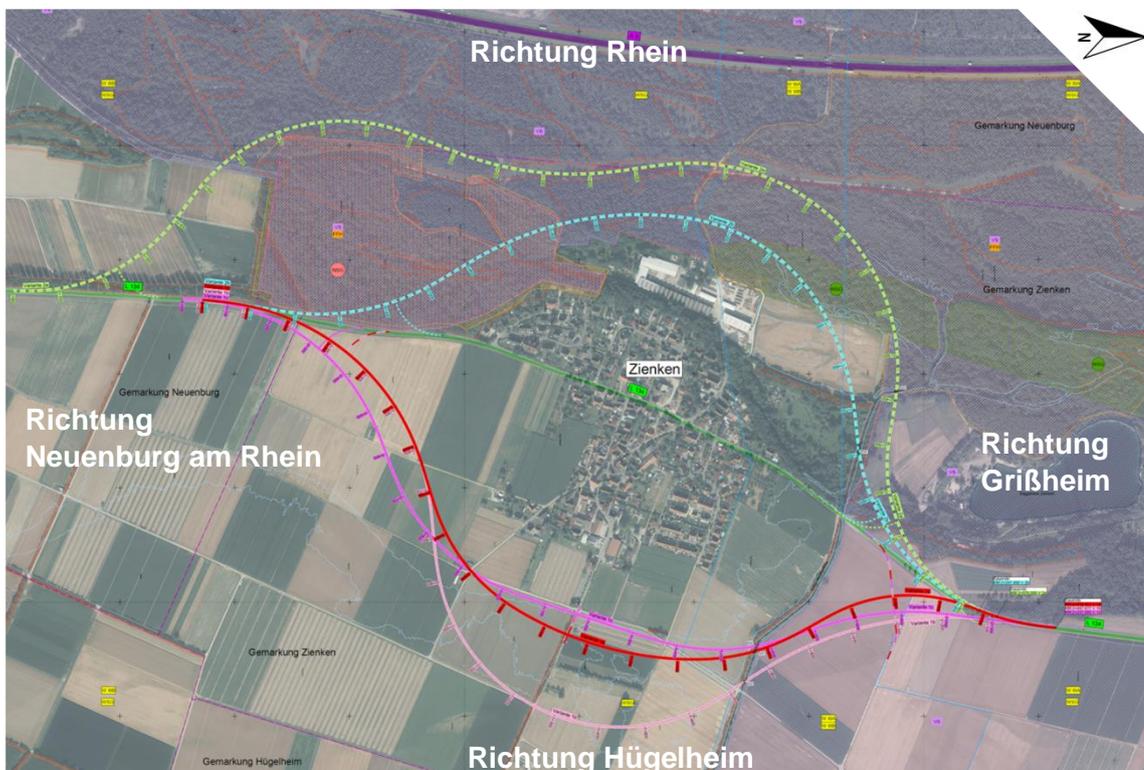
Übersichtslageplan mit Orthofoto (vgl. Unterlage Nr. U 3_2)
